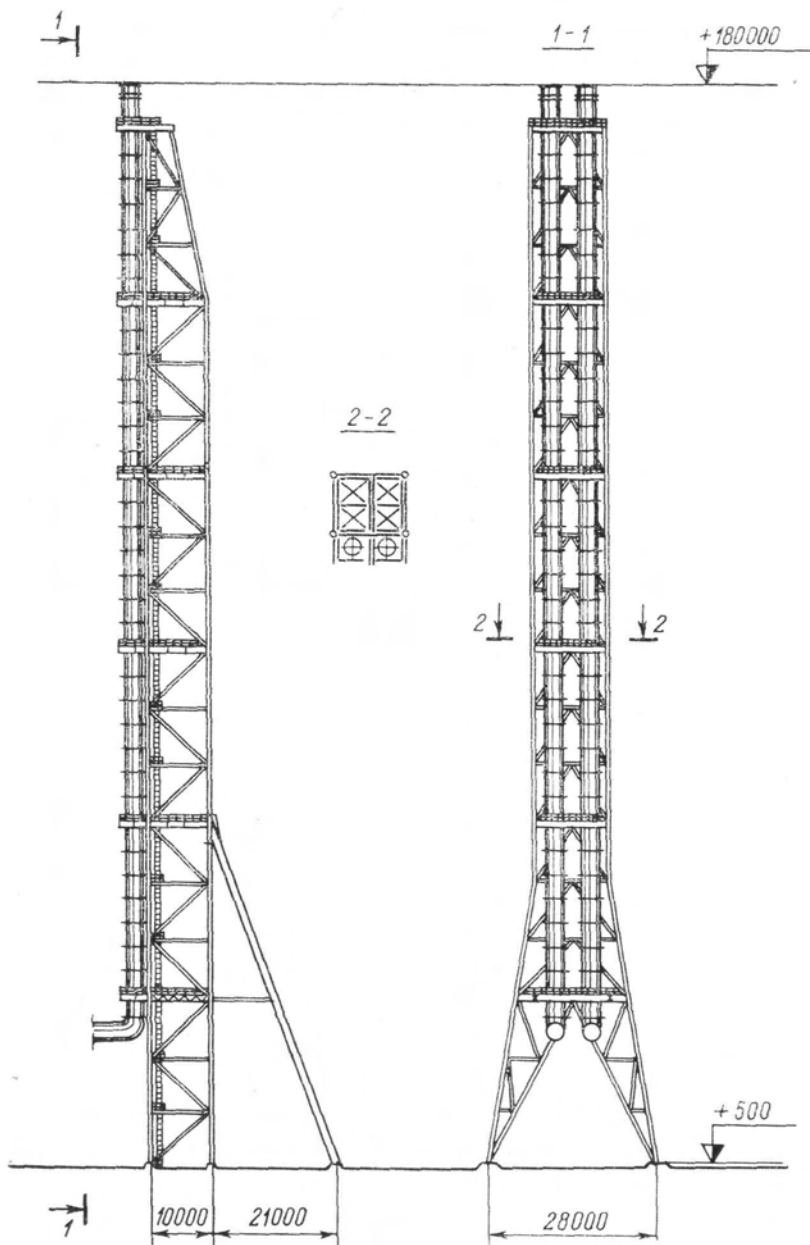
Общий вид вытяжной башни высотой 180 м с двумя газотводящими стволами, расположенными с наружной стороны несущей башни
